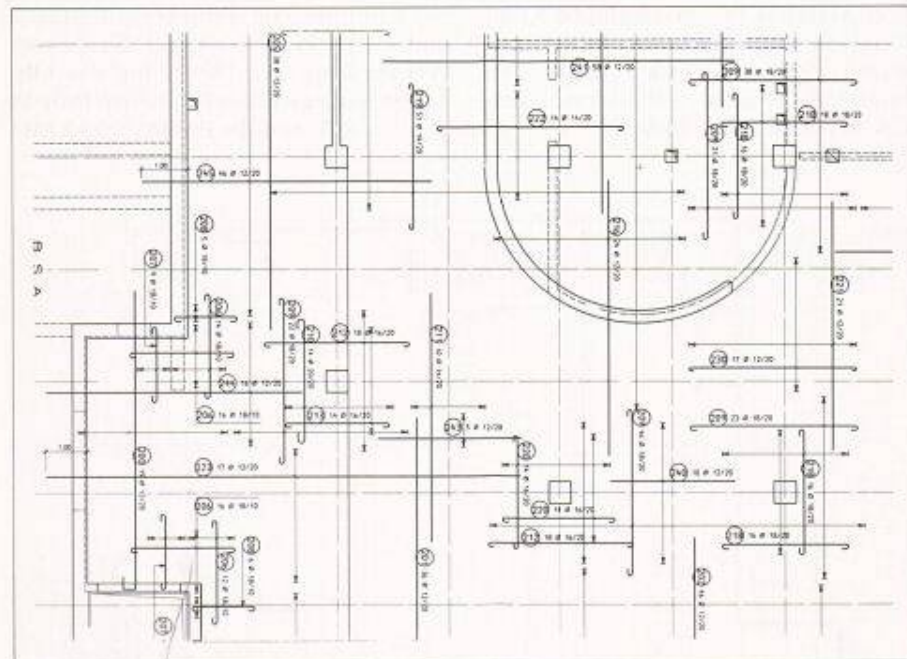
CAD-Armierungsplan erstellt mit SPEEDIKON
